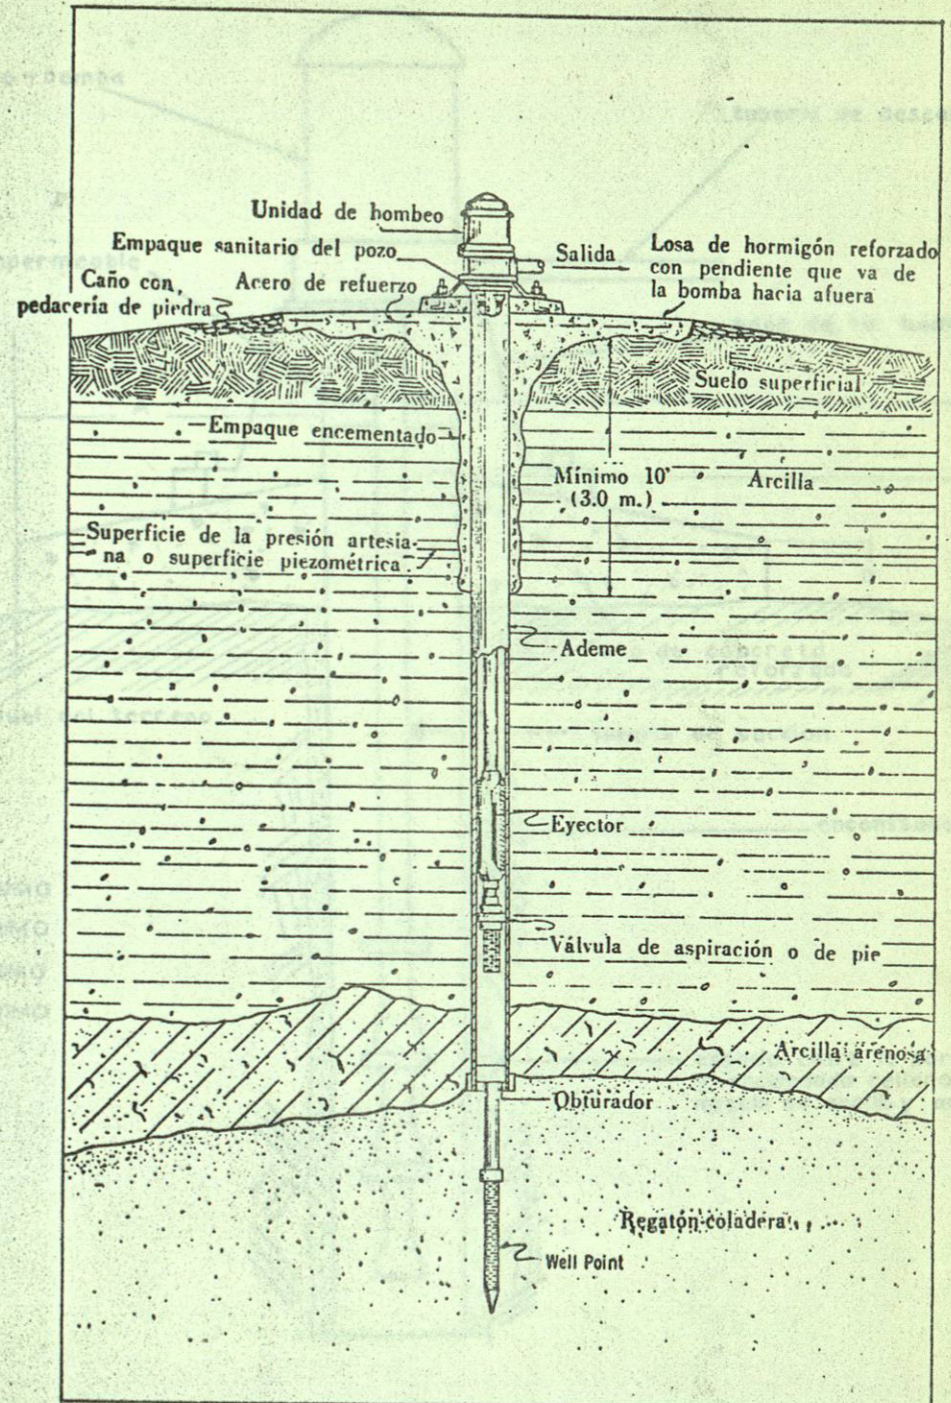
POZO BARRENADO CON REGATON COLADERA ("PICHANCHA") HINCADO
